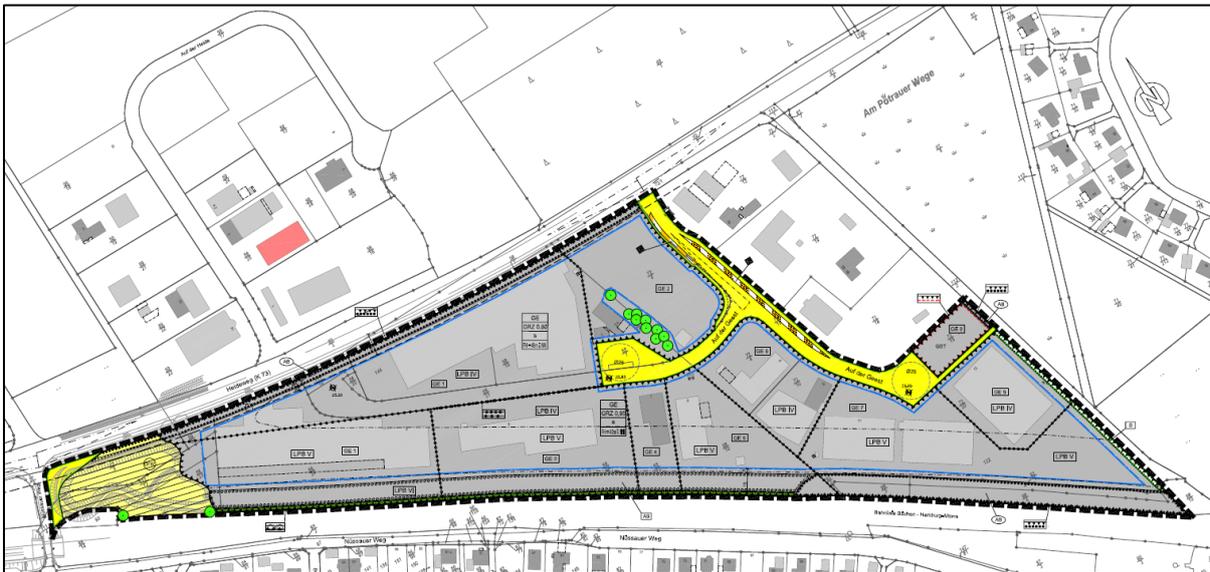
Ausschnitt 2. Änderung B-Plan Nr. 25, Quelle: Gemeinde Büchen
